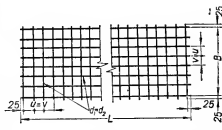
Сварная сетка с арматурой, одинаковой в обоих направлениях.
